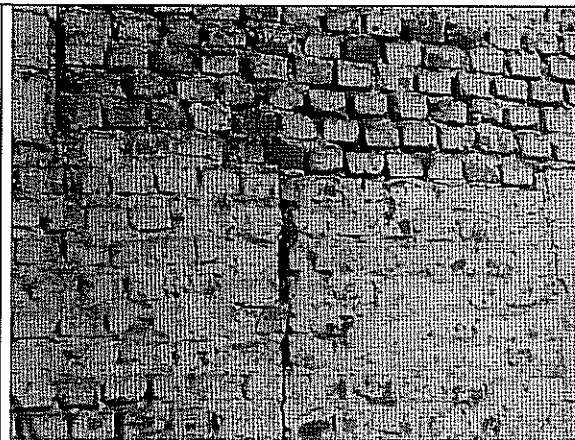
Agrietamientos y daños en las unidades de mampostería del muro del costado oriental.
